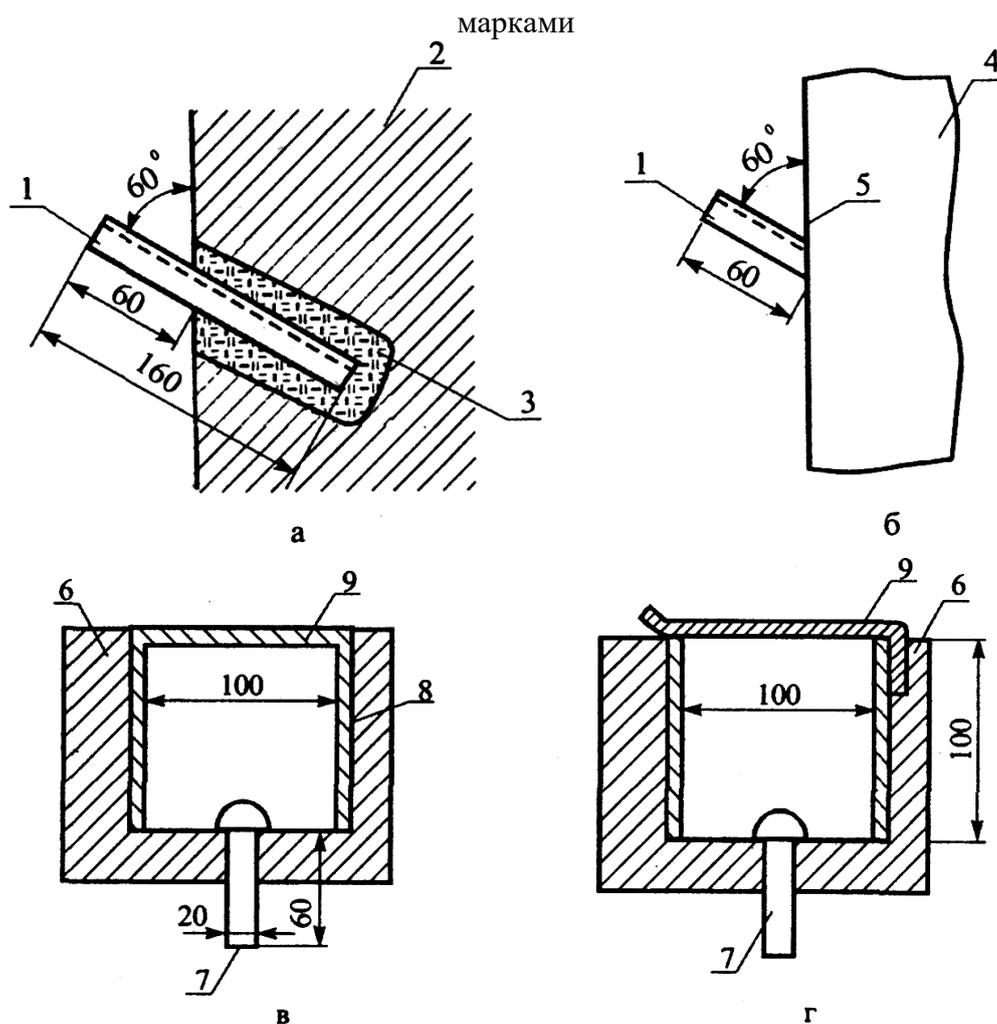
Нивелирные марки стенные (а и б) и в фундаментных плитах (в и г):
